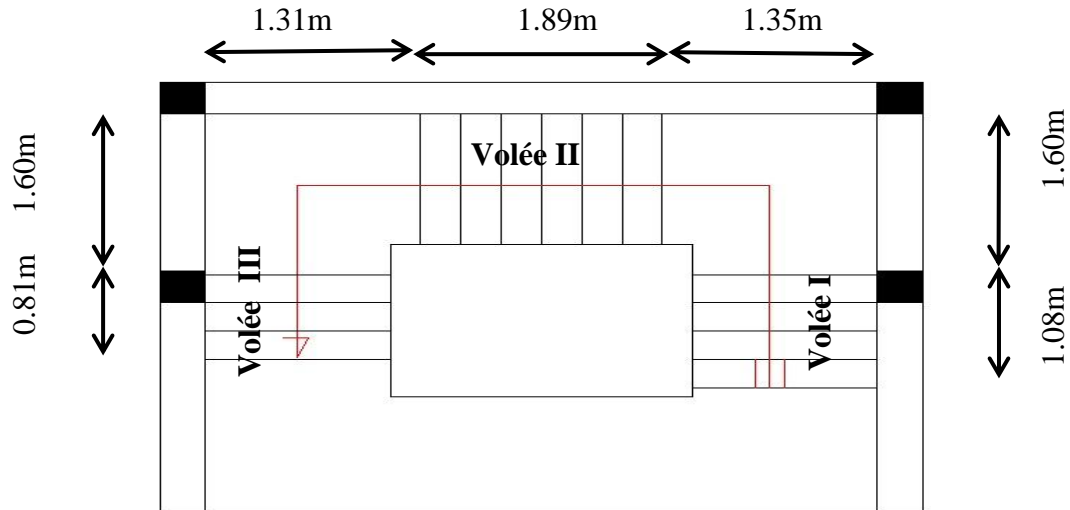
Vue en plan de l'escalier d'étage courante.
